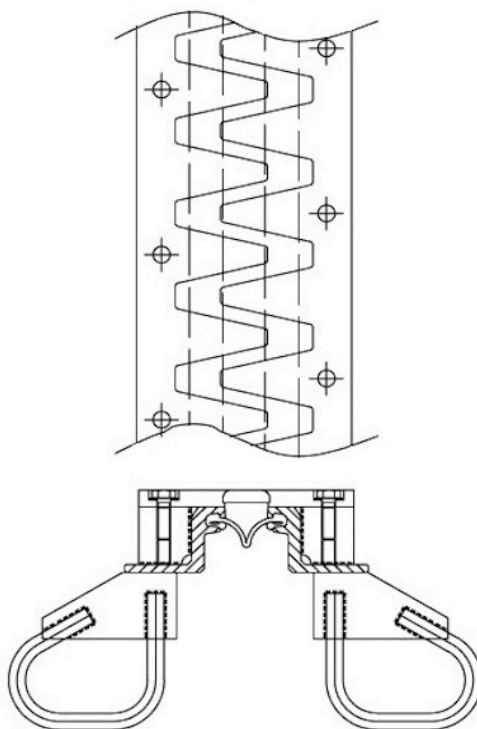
Конструкция однопрофильного ДШ с дополнительными элементами перекрытия
